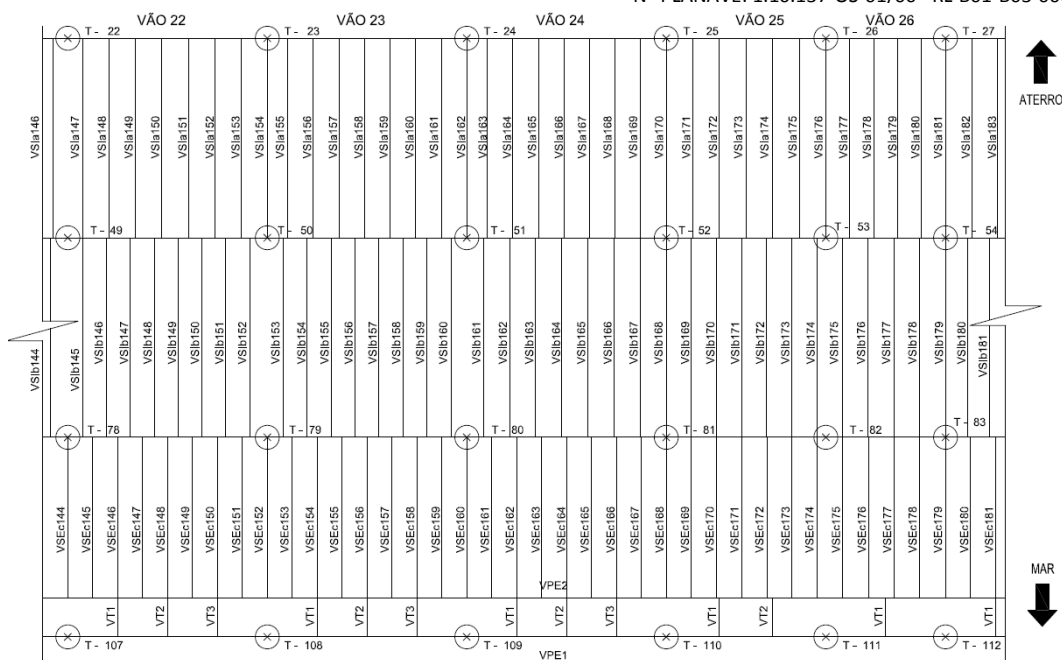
Planta do Berço 103 entre Vãos 22 e 26
